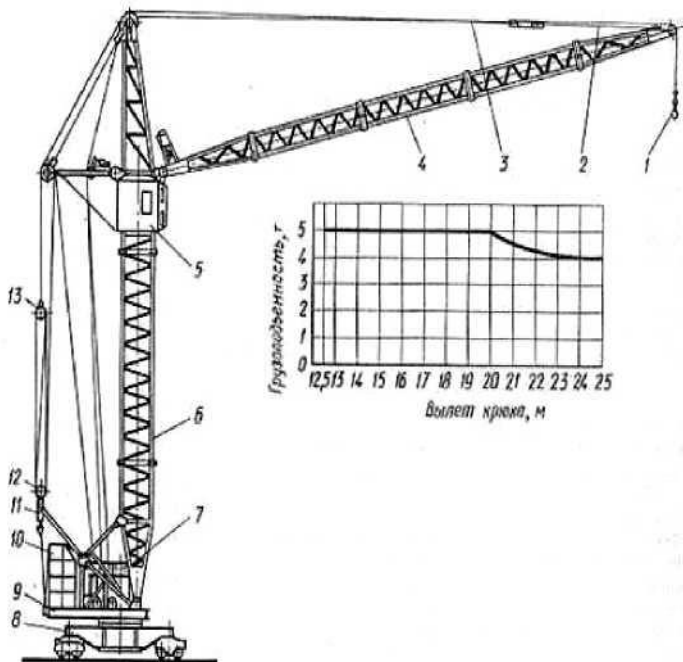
Башенный кран КБ-100. ОАС-1 с поворотной башней и его грузовая характеристика: 1 - крюк; 2 - стреловой канат; 3 - грузовой канат; 4 - стрела; 5 - кабина; 6 - башня; 7 - электрооборудование; 8 - рама ходовая; 9 - платформа поворотная; 10 - противовес; 11 - стойка монтажная; 12 - обойма нижняя; 13 - обойма верхняя
